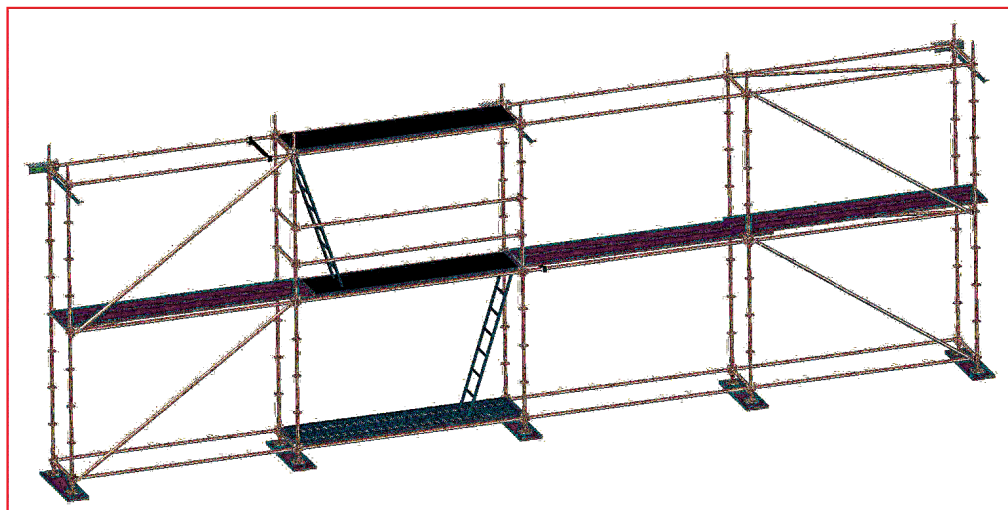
Przykład kotwienia rusztowania do elewacji
